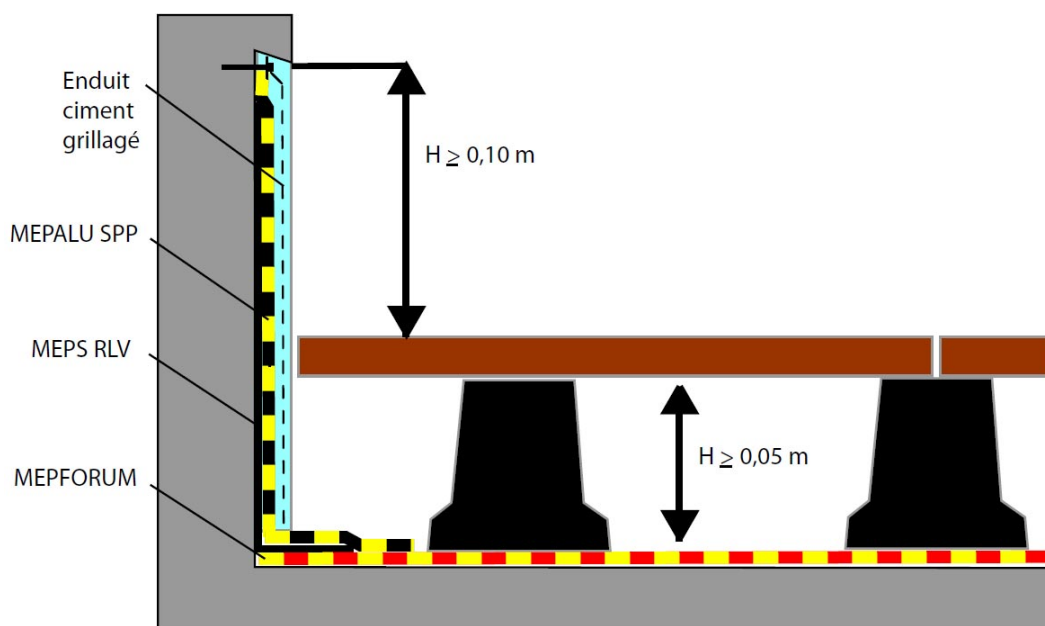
Exemple avec tête de relevé au-dessus du niveau fini de la protection directe par dalles sur plots
